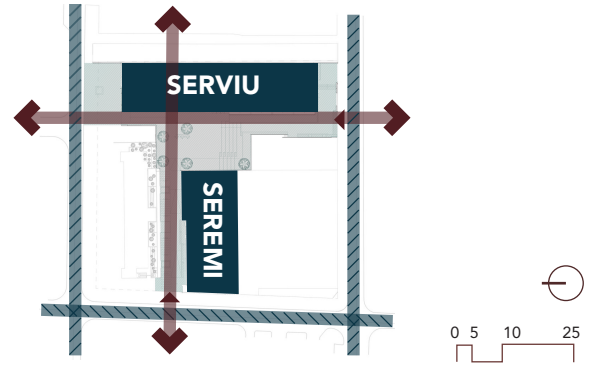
Emplazamiento de SERVIU (2015). Elaborado por el autor
